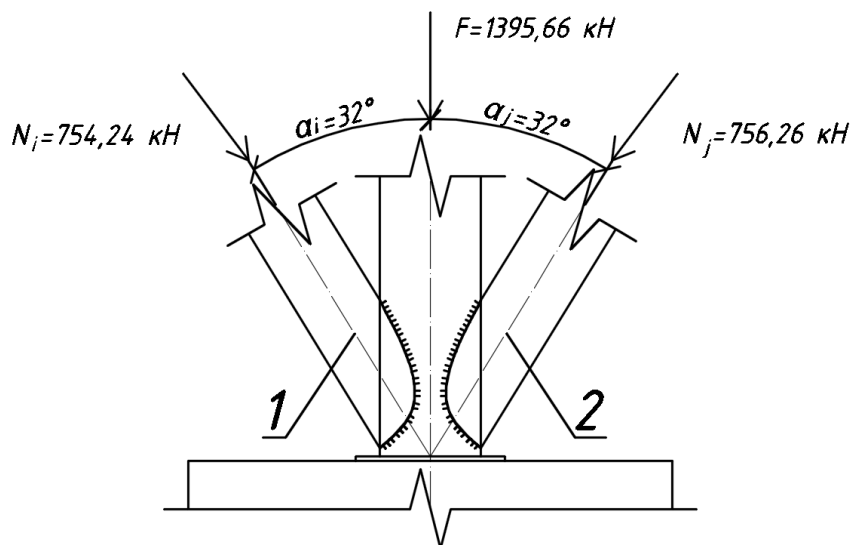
Расчетная схема узла для расчета на местный изгиб стенки СТ1
